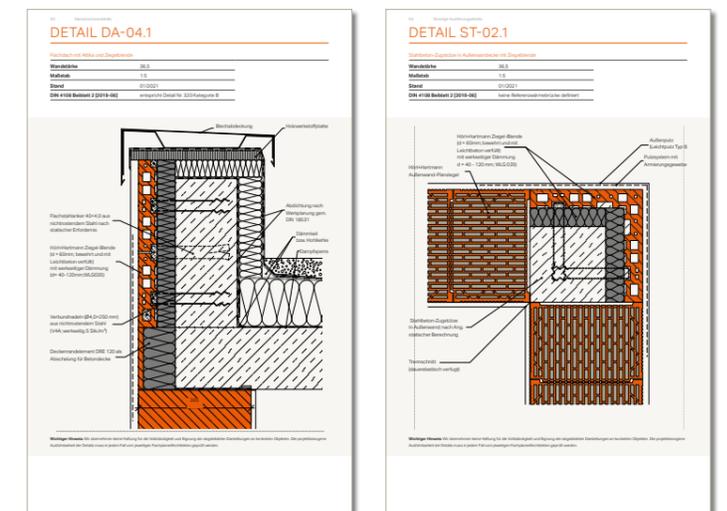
DETAIL DA-04.1 und Eckblende Detail ST-02.1.
